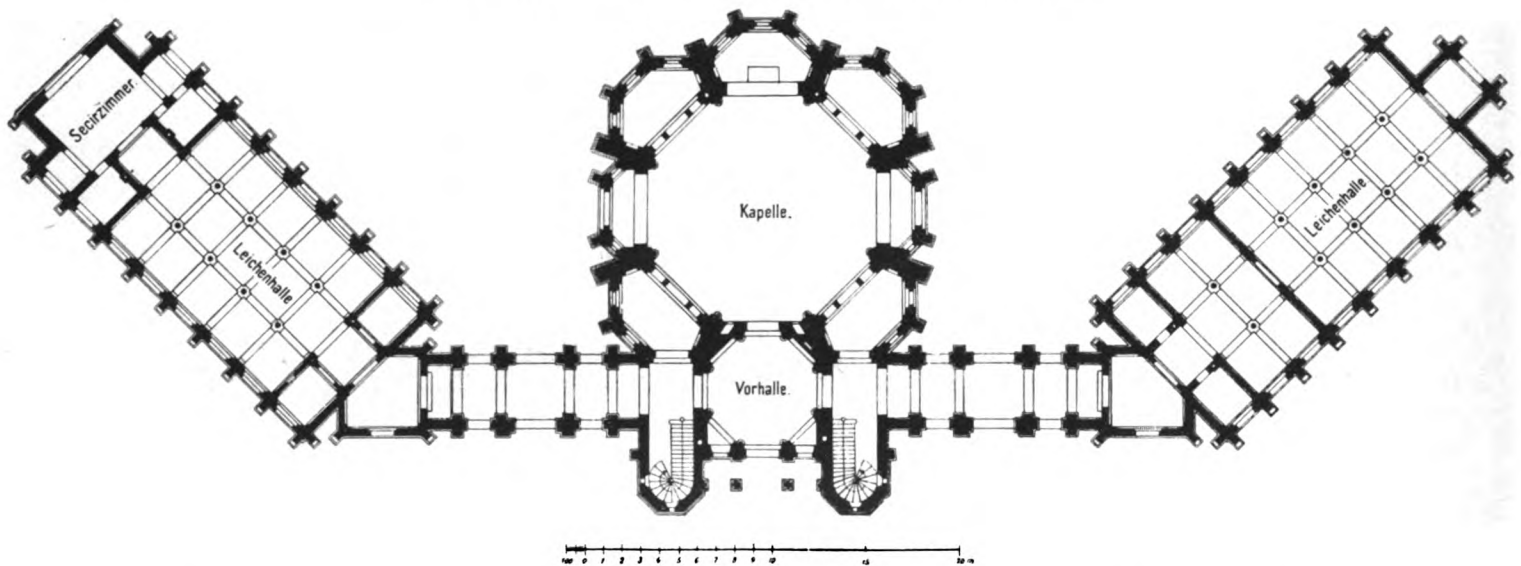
Kapelle und Leichenhallen. Erdgeschoss. 1:400.
